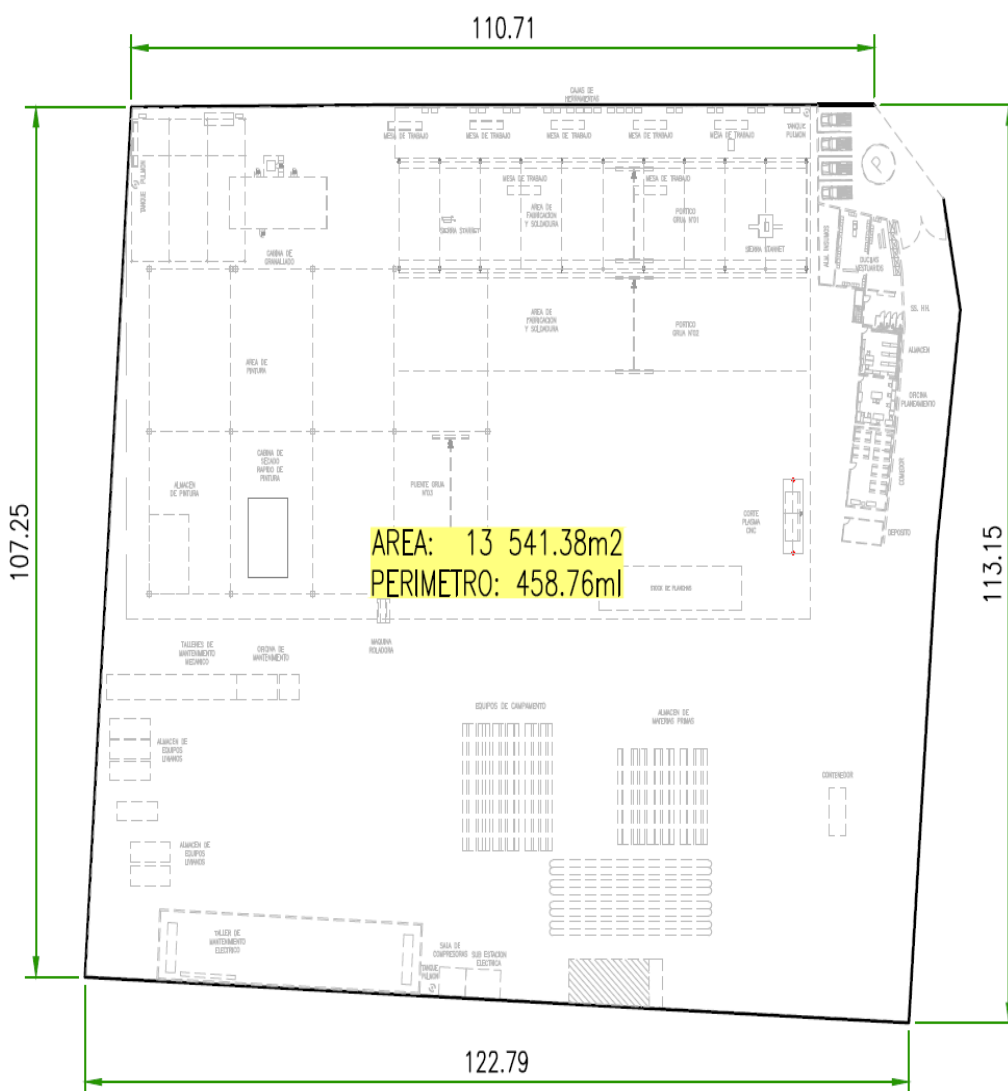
Área de la planta de metalmecánica de AiD INGENIEROS SAC.
